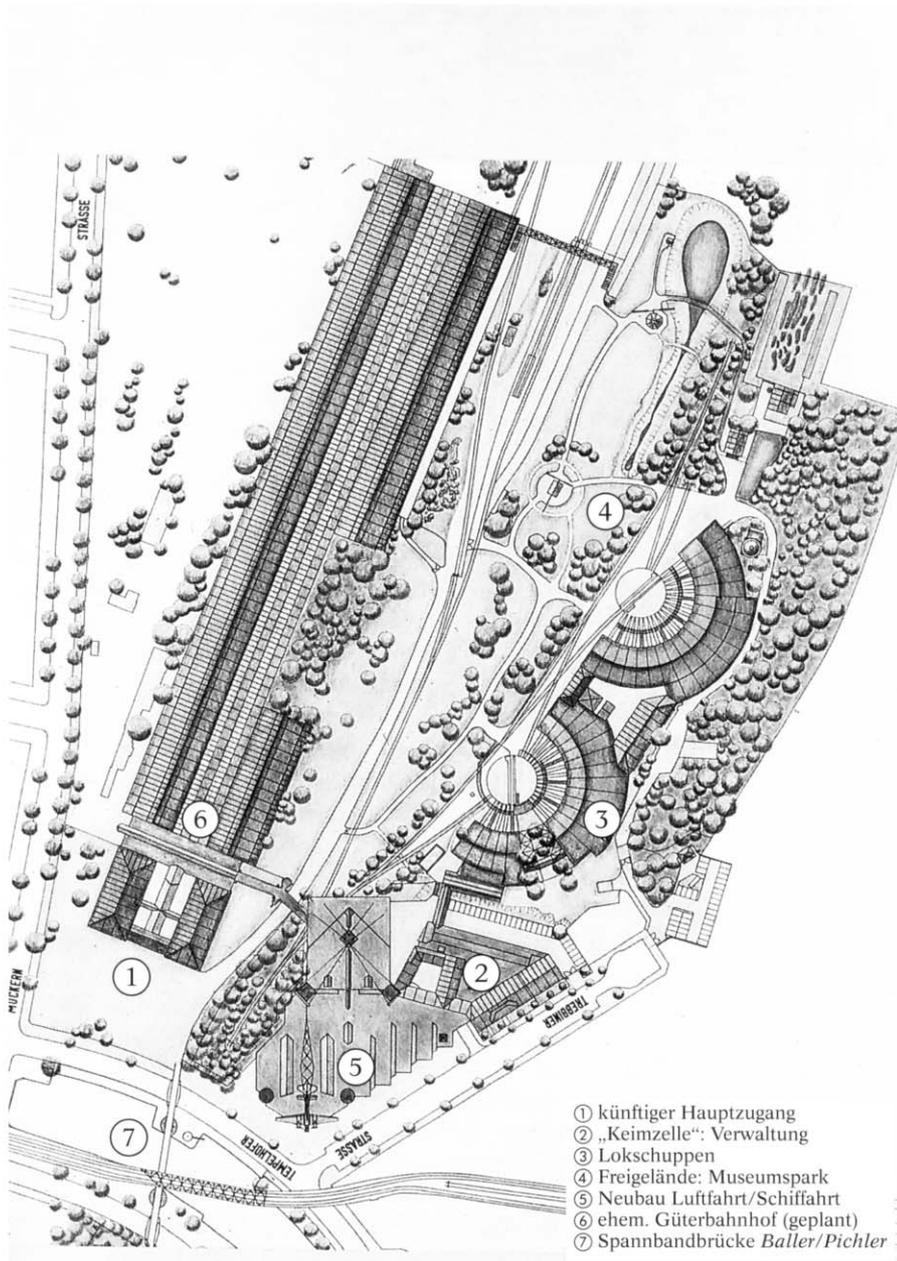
Übersicht über den gesamten Museumspark mit Neubau und geplanten künftigen Erweiterungen (Quelle: Landschaft Planen und Bauen)
